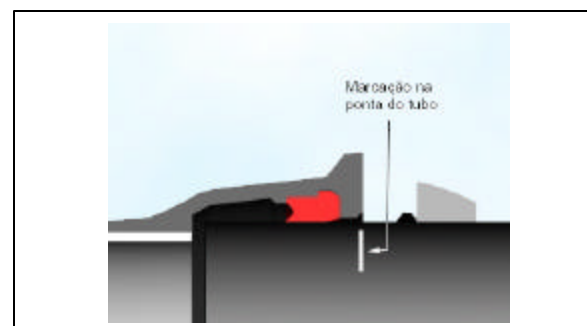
Concluída a aproximação dos tubos, o conjunto deverá apresentar a seguinte configuração.
